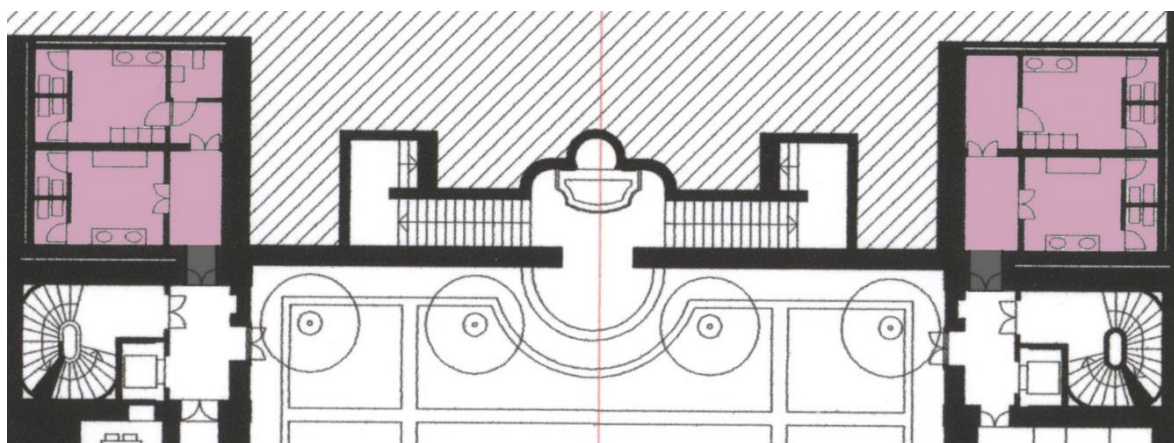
Planta esquemática onde se representa a área, em regime de cave, correspondente às instalações sanitárias, 2013; Autora
